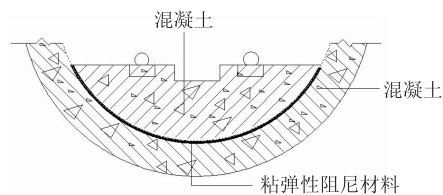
隧道内喷涂粘弹性阻尼材料施工示意图
